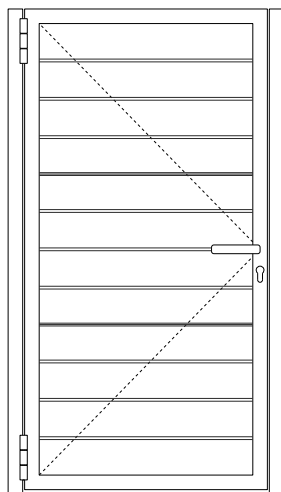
Detalle de alzado de puerta batiente peatonal de 1 hoja.
